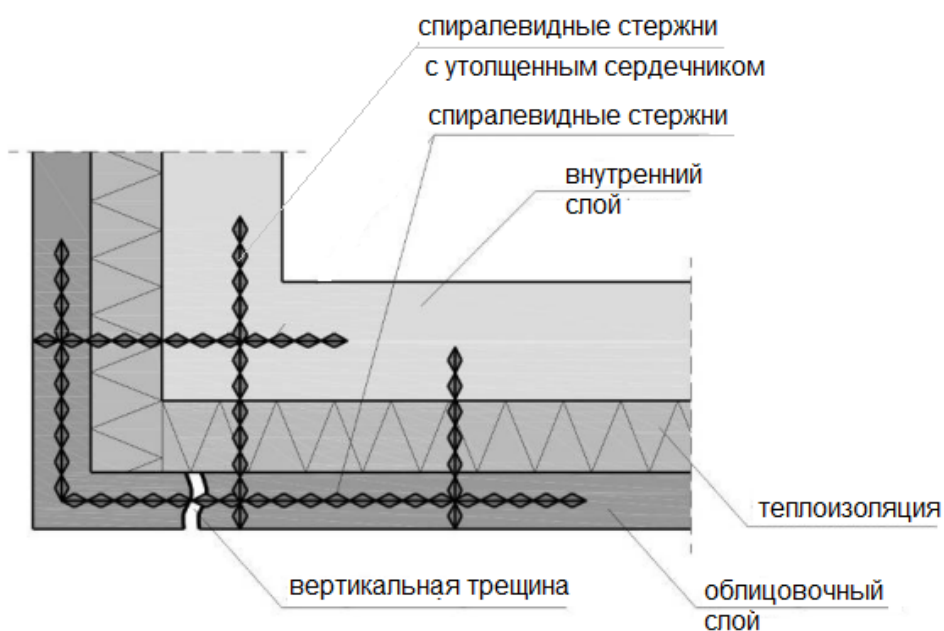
Соединение слоев многослойных стен в угловой зоне
